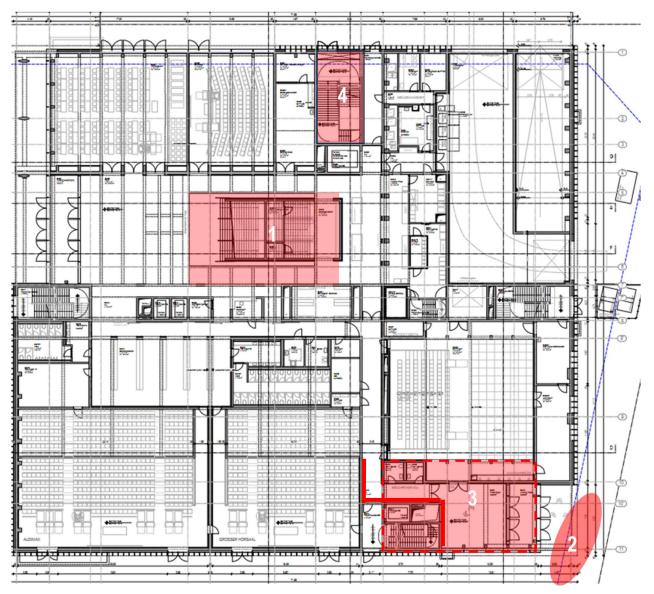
Grundriss EG, Standorte erstrecken sich teilweise über mehrere Etagen bzw. sind nicht im EG verortet.
